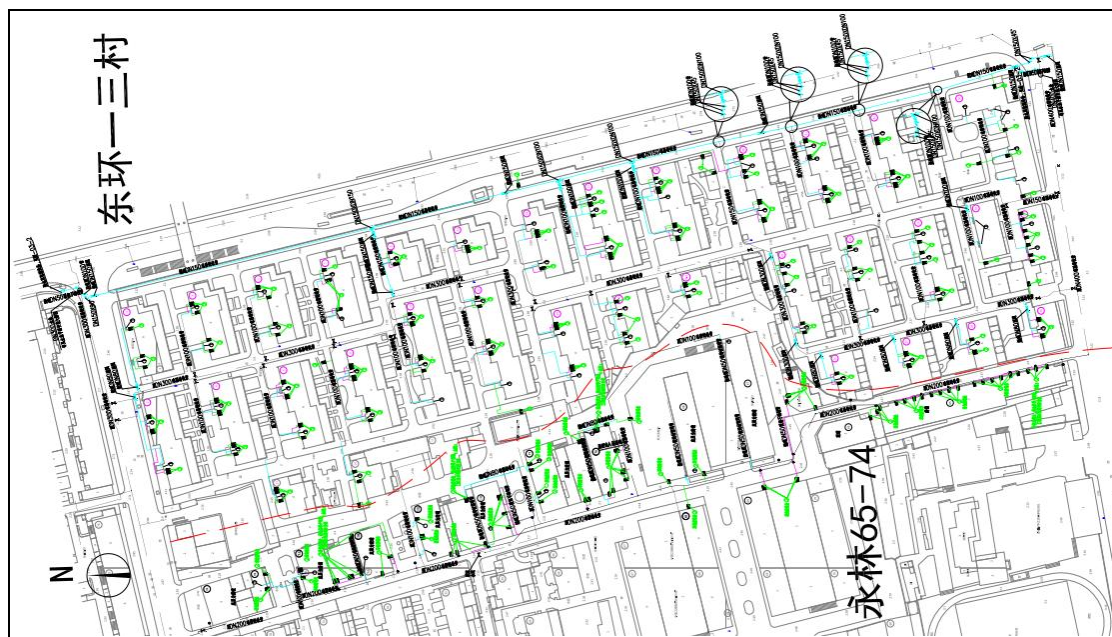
工程总平面布置图三（东环一三村、永林新村 65-74）
